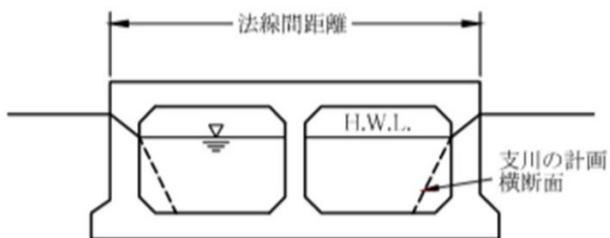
樋門の断面説明図（流下断面積が1:1.3以内の場合）
